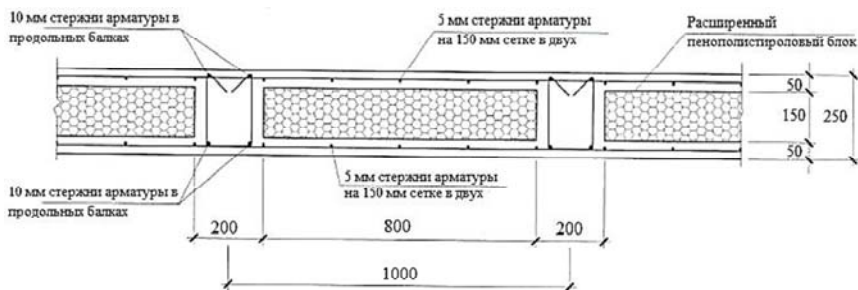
Поперечное сечение железобетонного перекрытия системы «Монофант»
